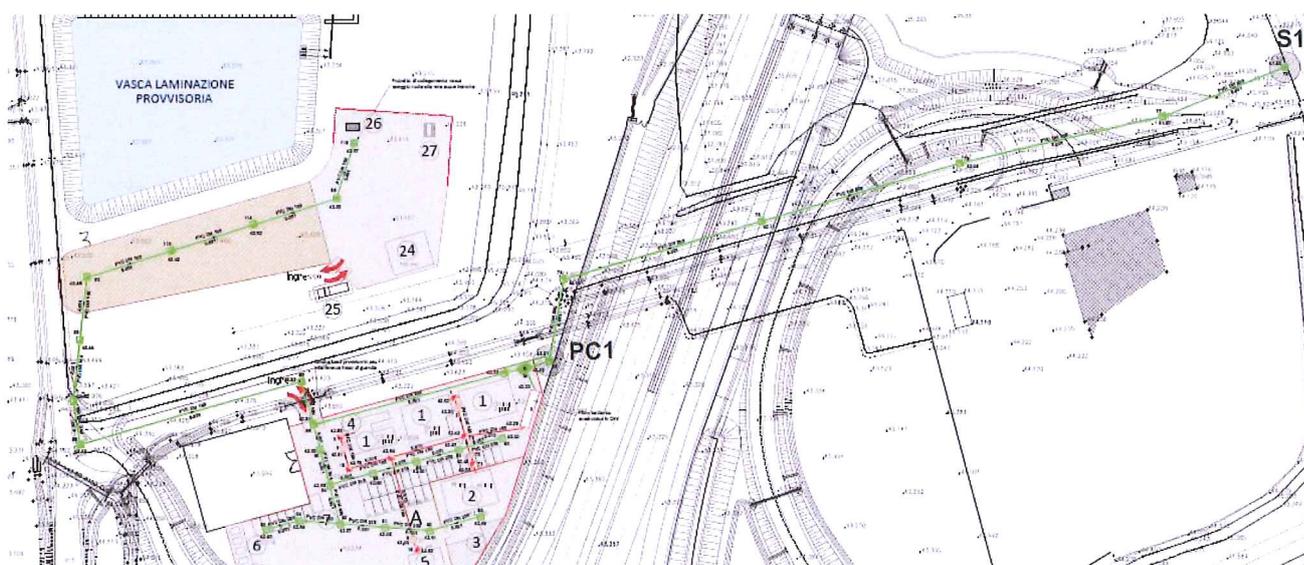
Lay-out delle reti fognarie a servizio dell'area logistica di cantiere – lato Sud.
